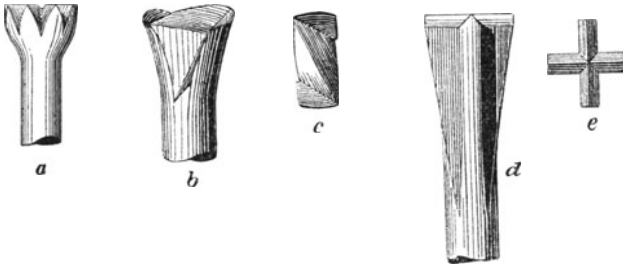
Kronen-, Z- und Kreuzbohrer.
